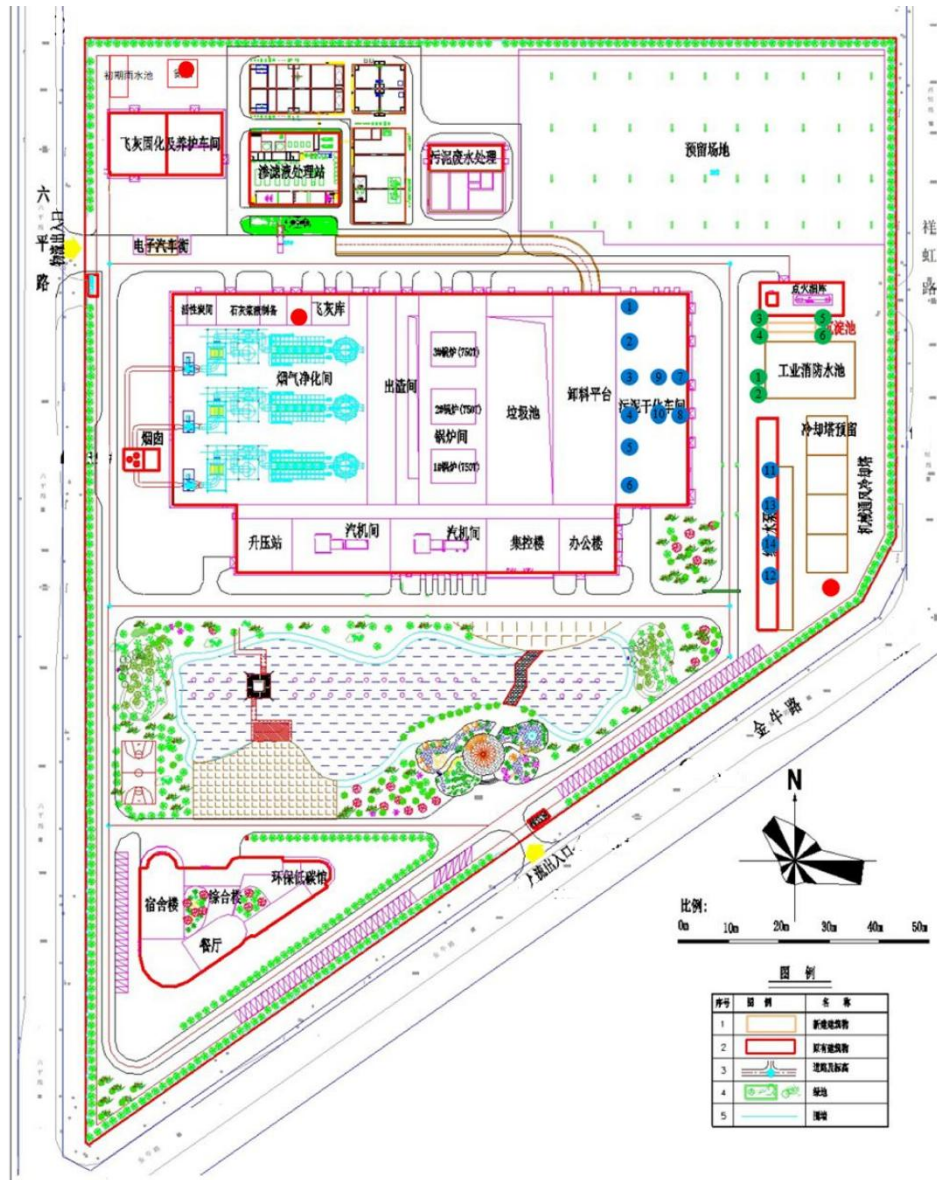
企业厂区平面布置图（本项目在现有厂区实施）
